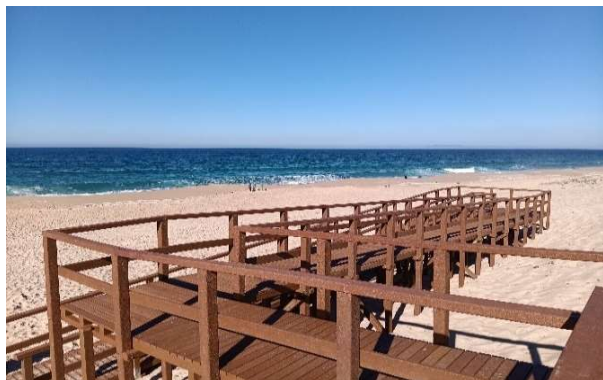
e 21 – Fotografias finais da obra de alteamento do passadiço
